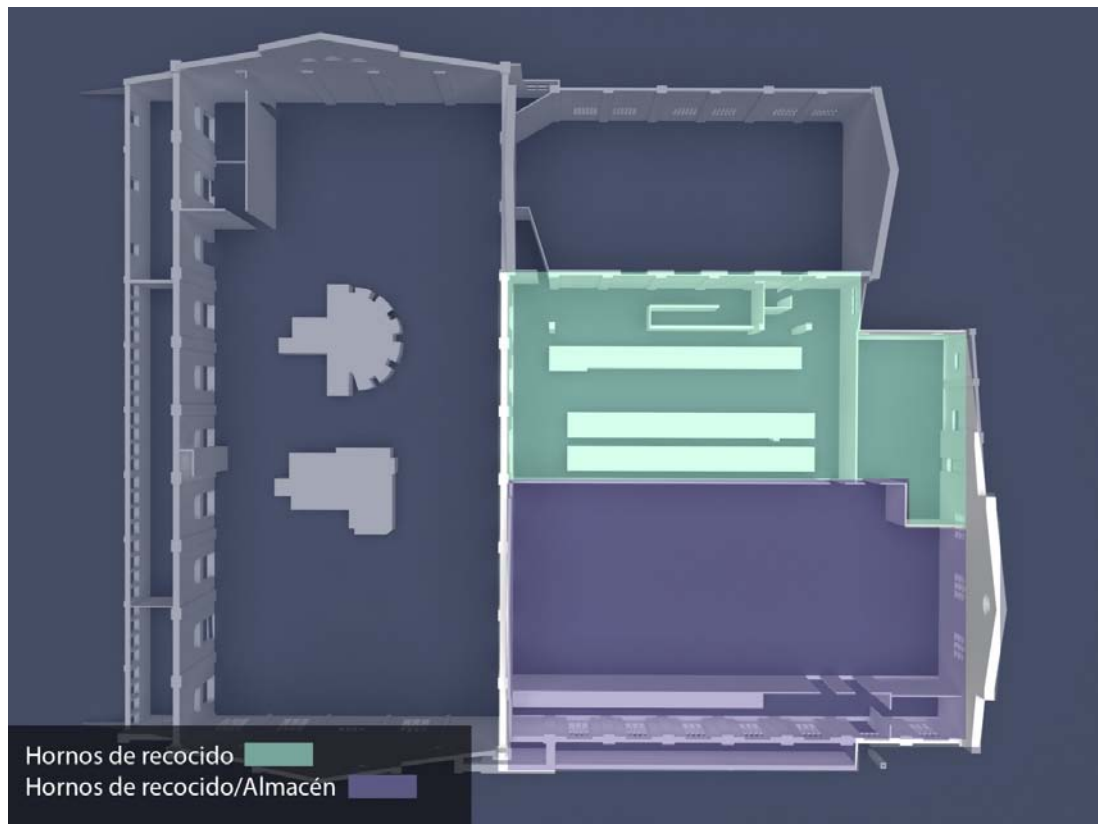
Distribución en planta (Primera Baja (nave2))
